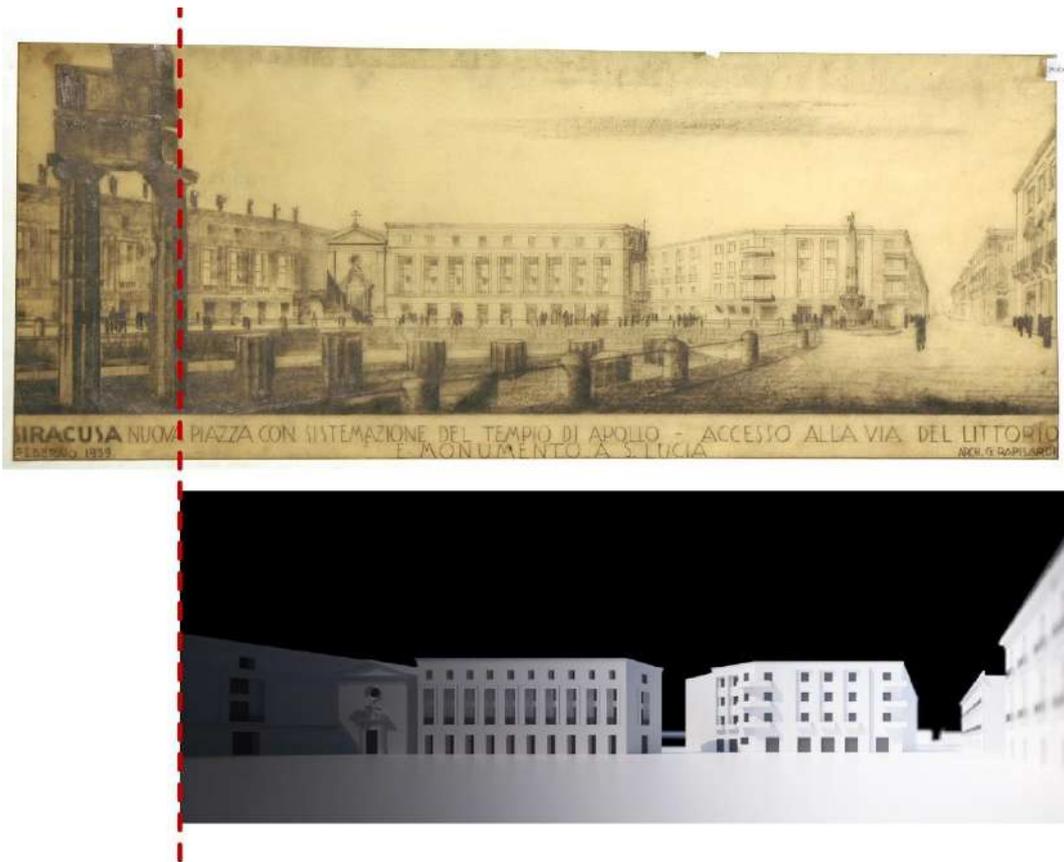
Confronto tra la prospettiva di Gaetano Rapisardi e il modello costruito secondo la restituzione prospettica; vista su via del Littorio. Elaborazione dell'autrice.
